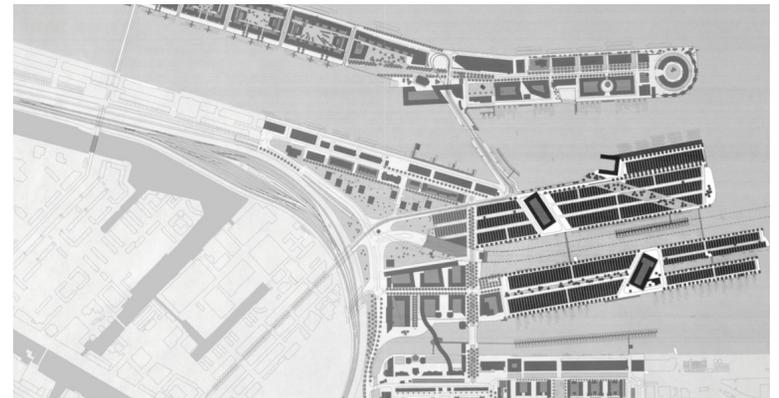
Master Plan Borneo Sporenburg. Fuente: West 8 Urban Design and Landscape Architecture. <http://urbandesignstudio.net/assets/borneo-2.pdf>
